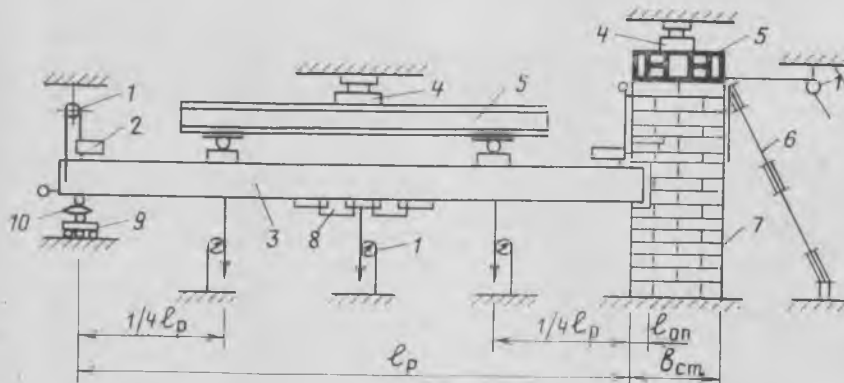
Схема испытания однопролетного фрагмента перекрытия, заземленного на опоре в кирпичной кладке
